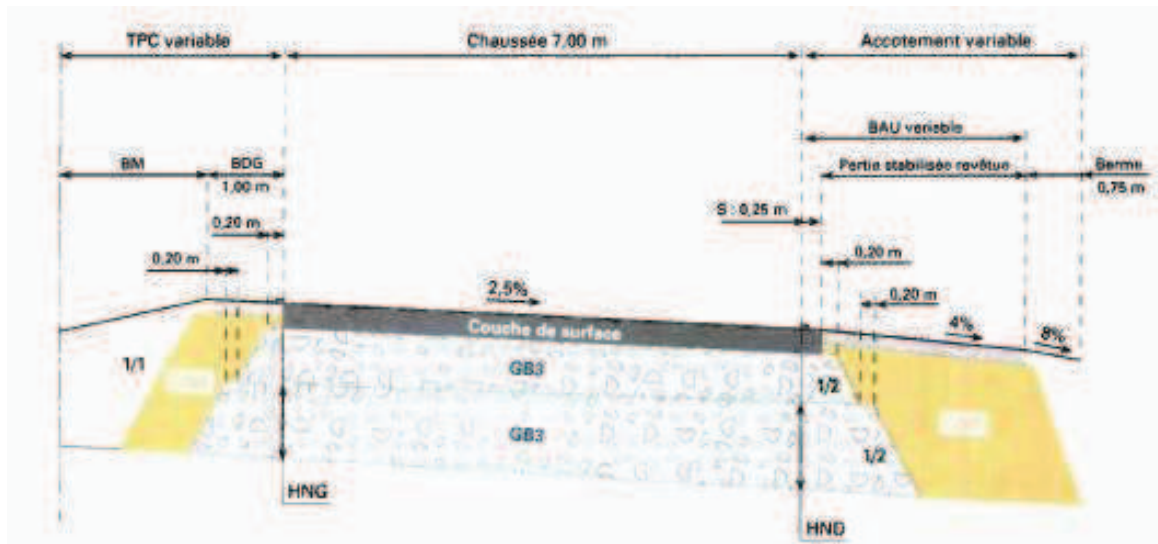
Secció transversal tipus d'una Structure bitumineuse épaisse GB3/GB3. Catalogue de structures de chaussées [SETRA].
